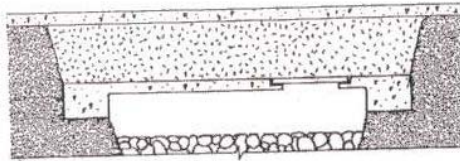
b: Alternativas de cubiertas. Losa con tapa bajo superficie impermeable.
